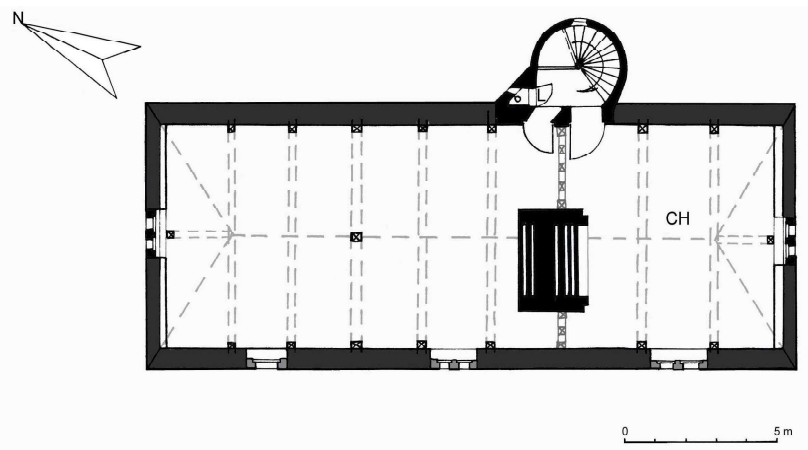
Mentheville. Plan restitué du deuxième étage entre 1595 et 1606.
